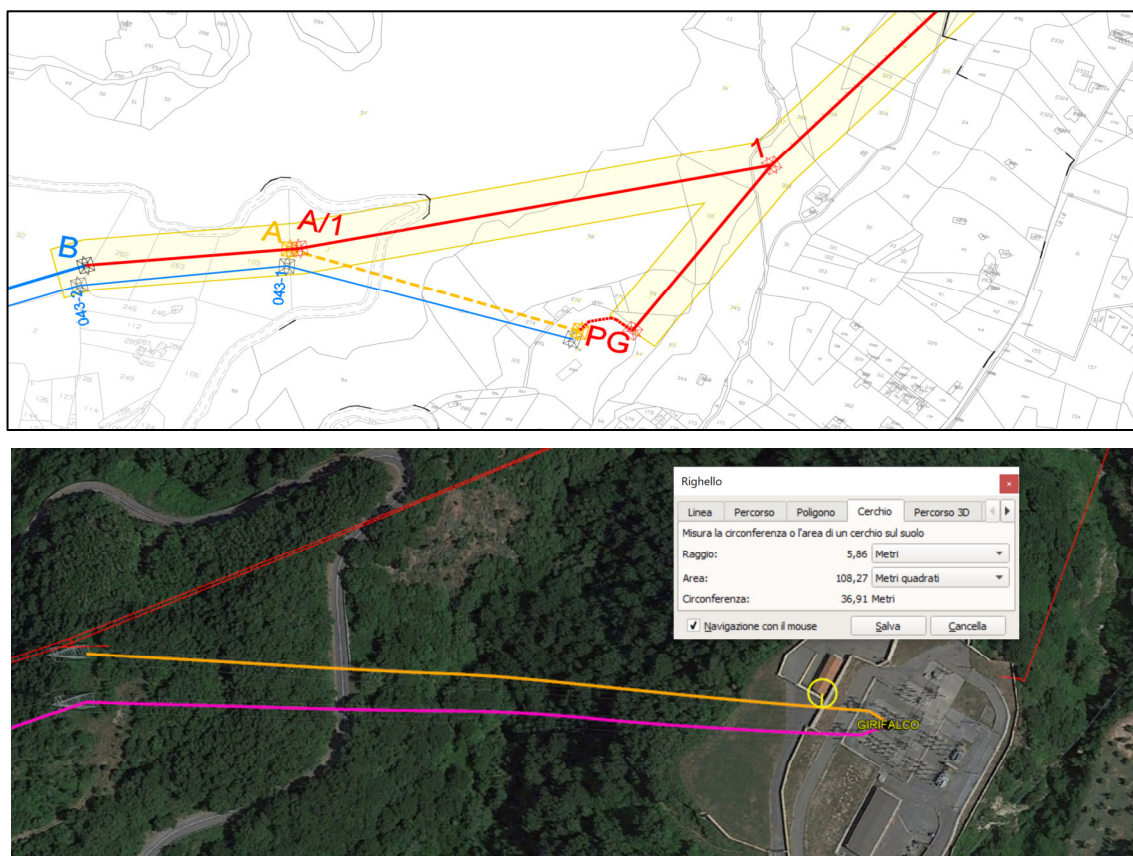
tratto della planimetria catastale ed ortofoto richiamato nell'osservazione
